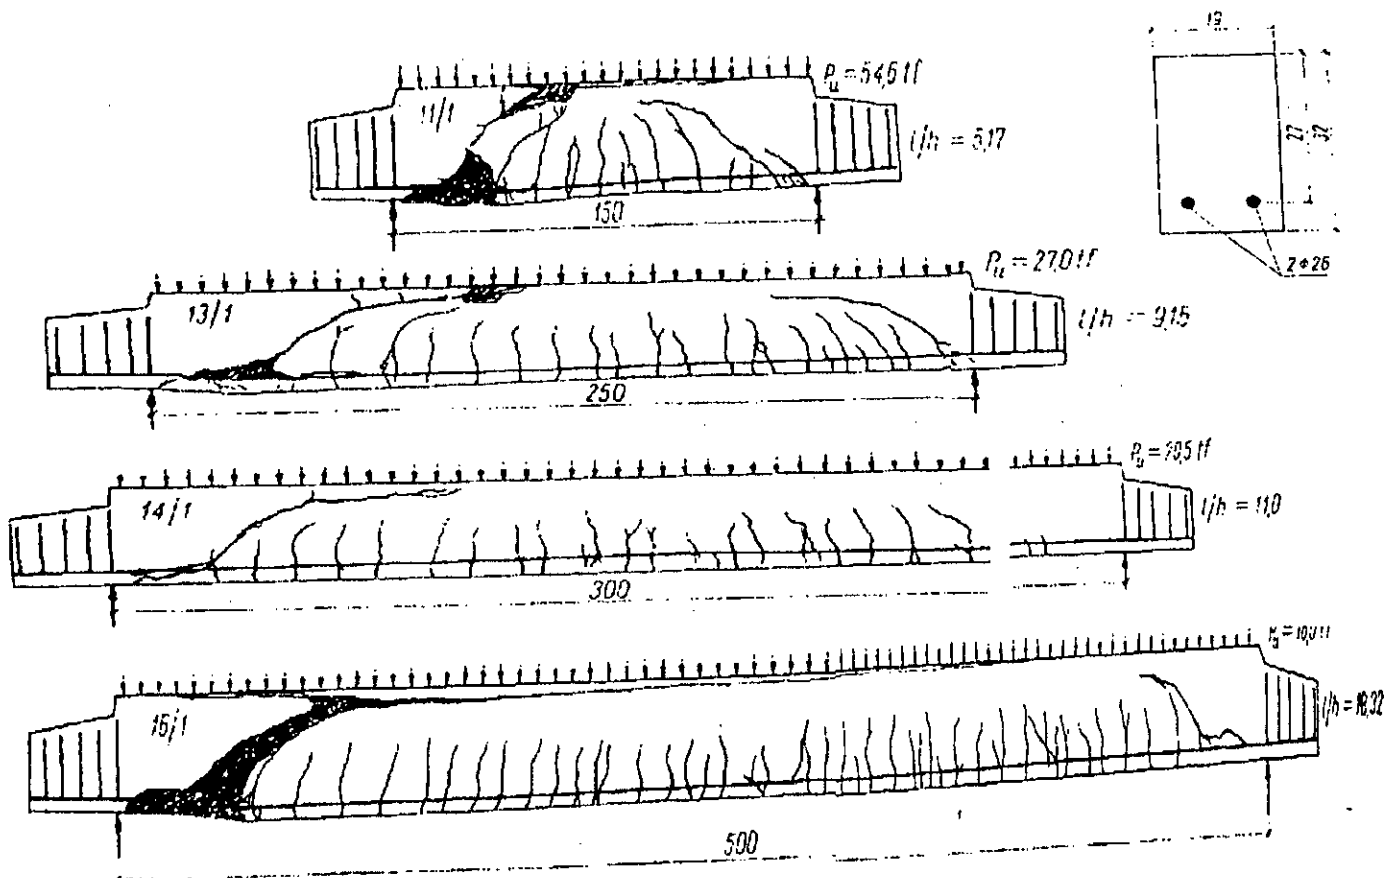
Fissuration des poutres chargées uniformément dont l'élançement de cisaillement est différent.
